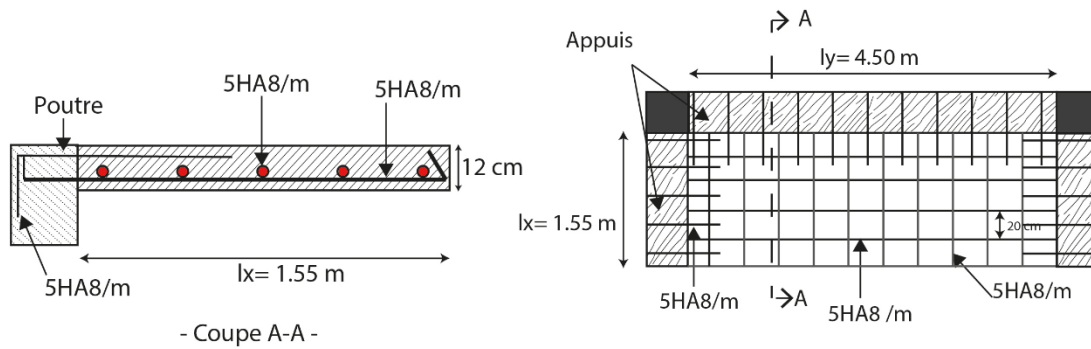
Schéma de ferrailage dalle sur 3 appuis.
